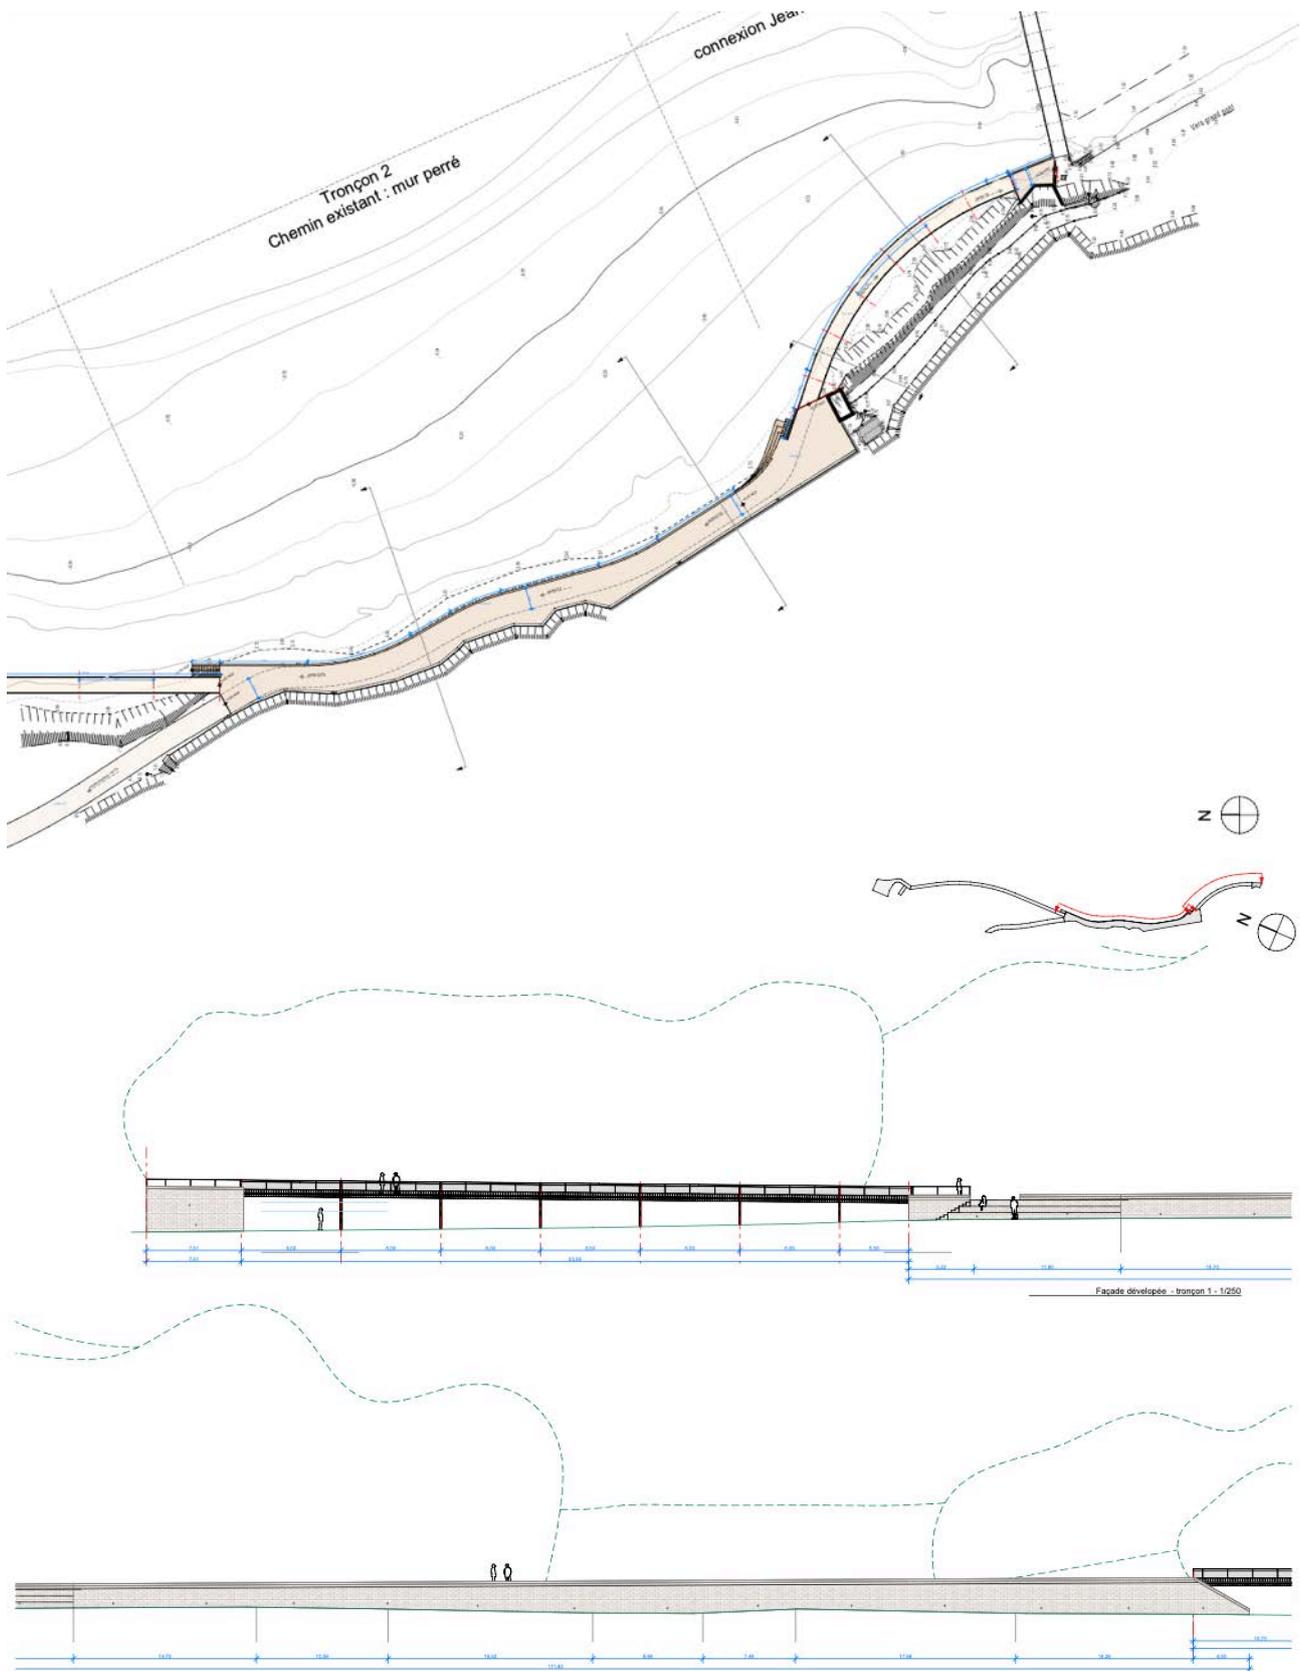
Vue en plan et en façade des tronçons T1 et T2 (Source Atelier Confluence)
